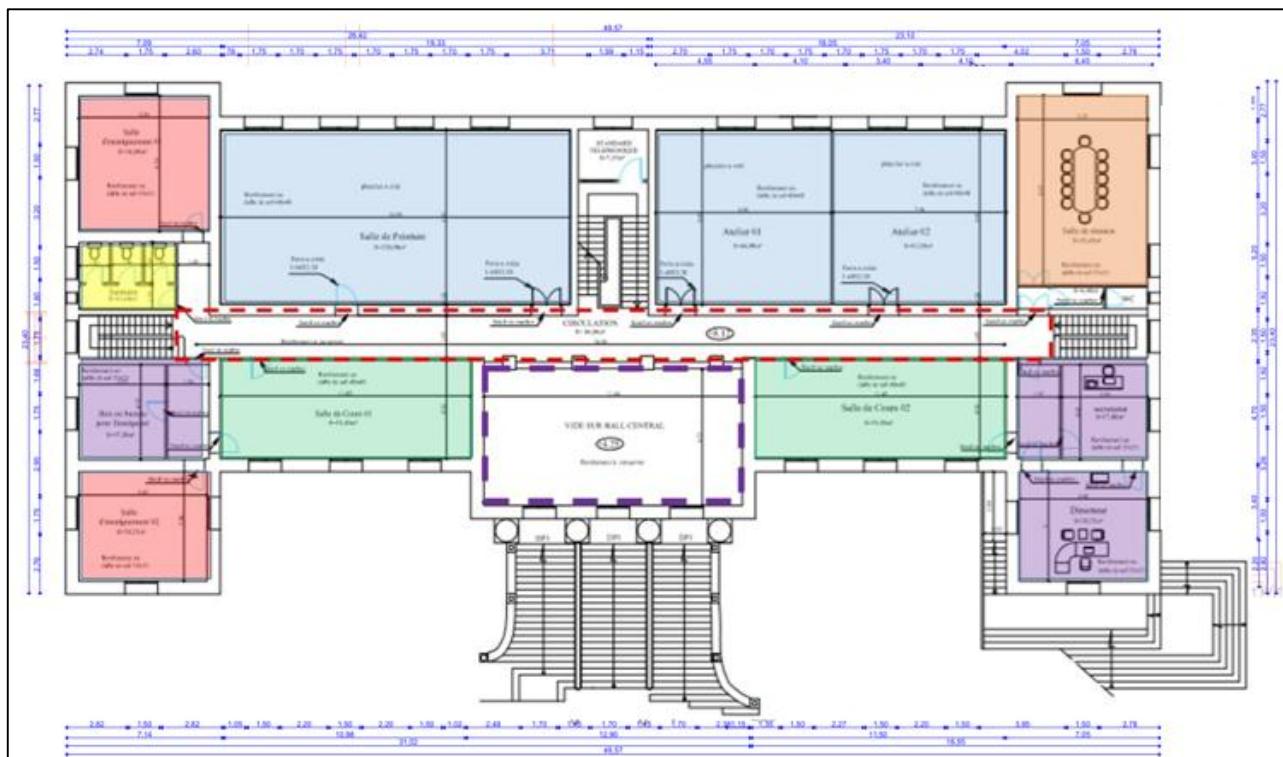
Plan de l'étage avec cotations (Fond : plan de la direction de l'urbanisme. Traitement : auteur 2025.).
